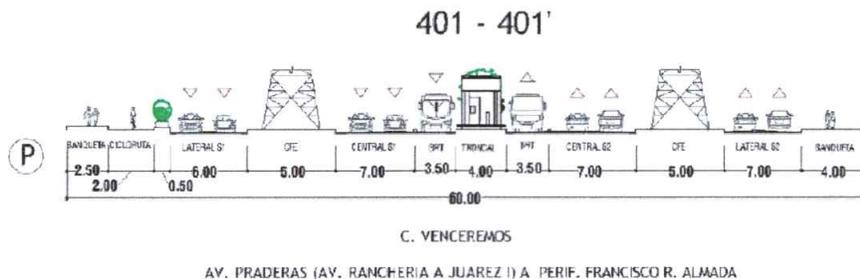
Sección vial futura C. Venceremos. Fuente PDU 2040 vigente.
